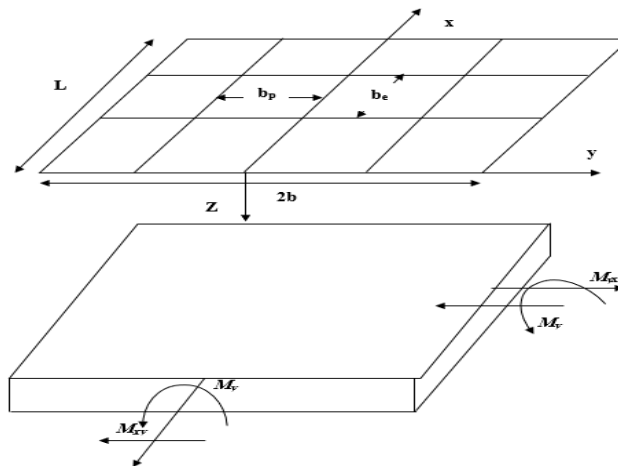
30 : Réseau des poutres du tablier d'un pont à poutres
